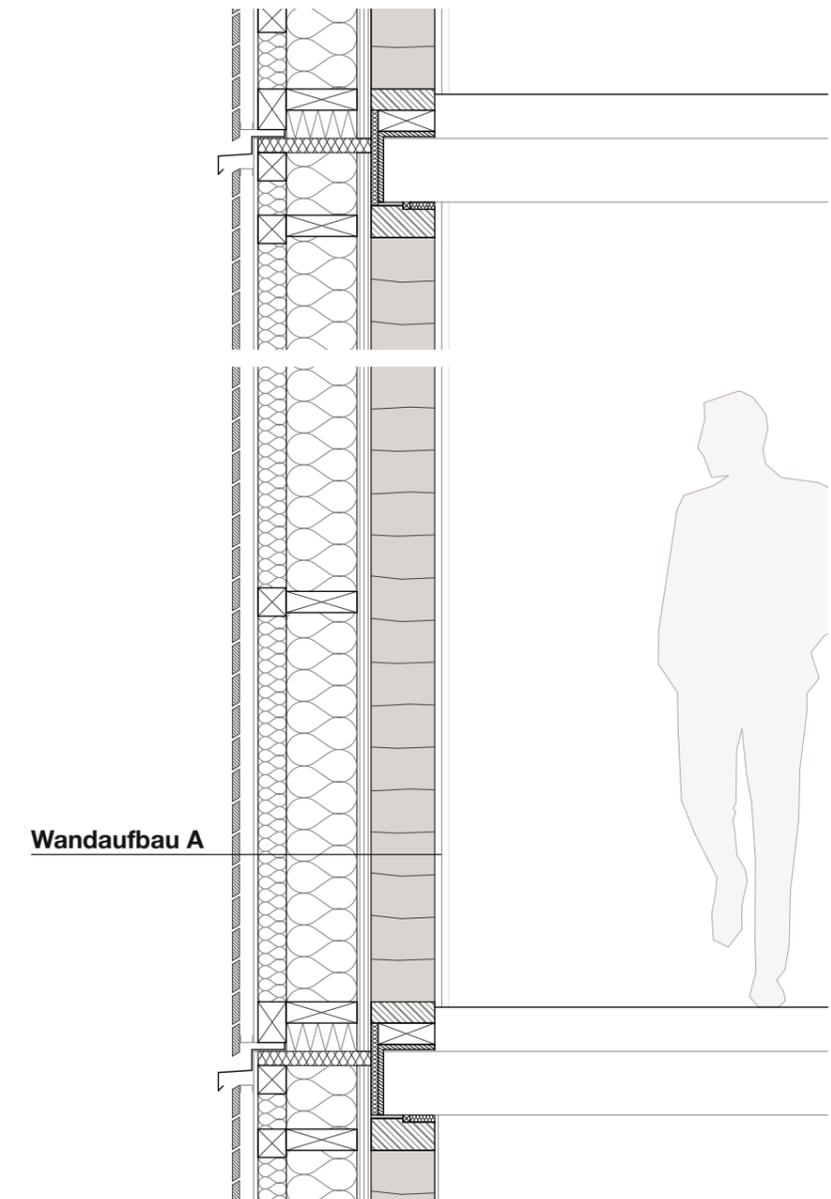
Beispielschnitt einer vorgefertigten Hybridfassade aus Lehm und Holz, Ausfachung für ein Stahlbetonskelett
